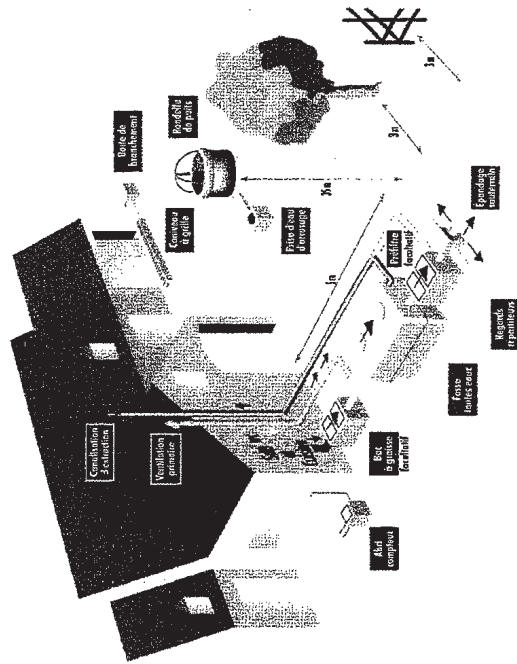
schéma d'implantation d'un dispositif d'assainissement autonome
